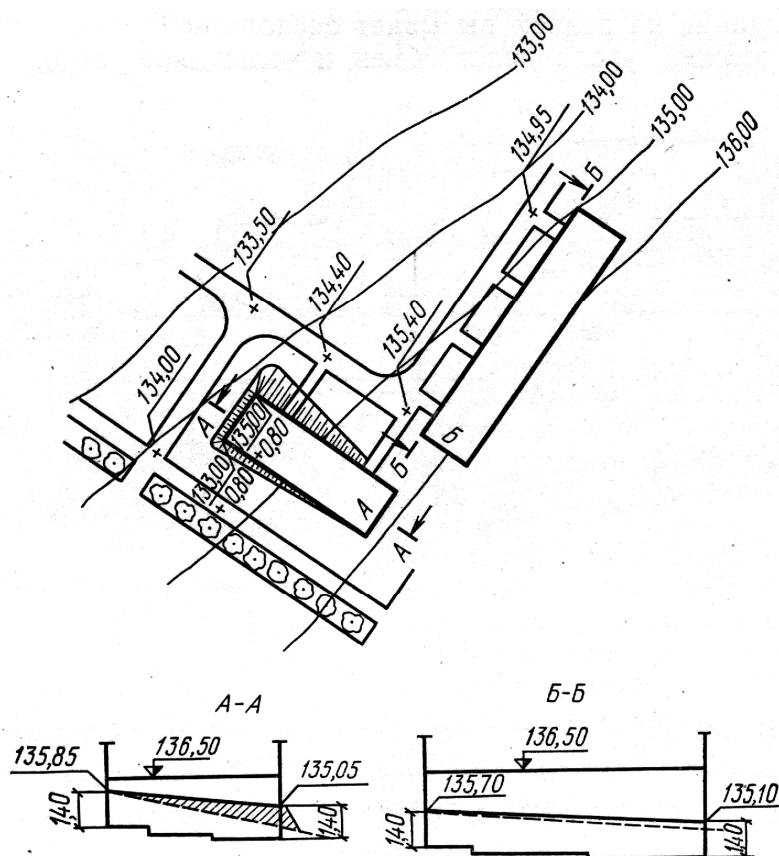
Схема вертикального планування групи житлових будинків. План і розрізи: А – вертикальне розташування будинків поперек горизонталі; Б – паралельне розташування будинків вздовж горизонталі.
